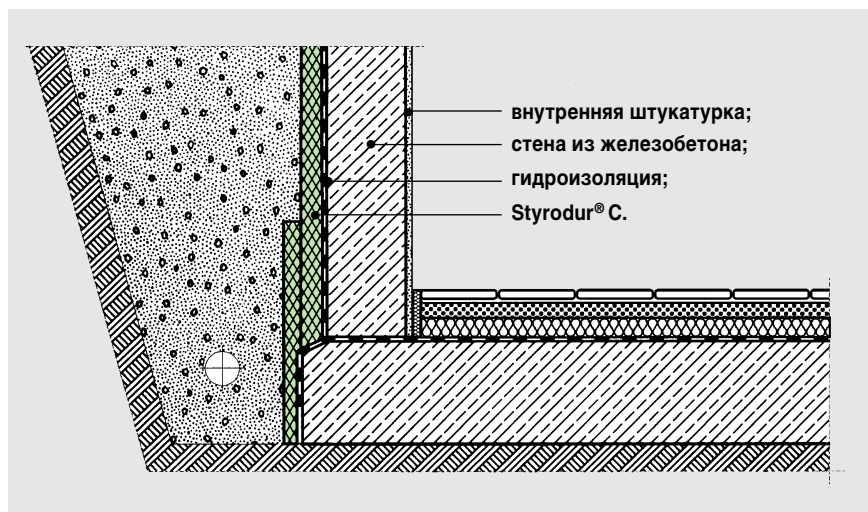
Основание теплоизоляции по периметру. Плита Styrodur® C стоит на фундаменте.
